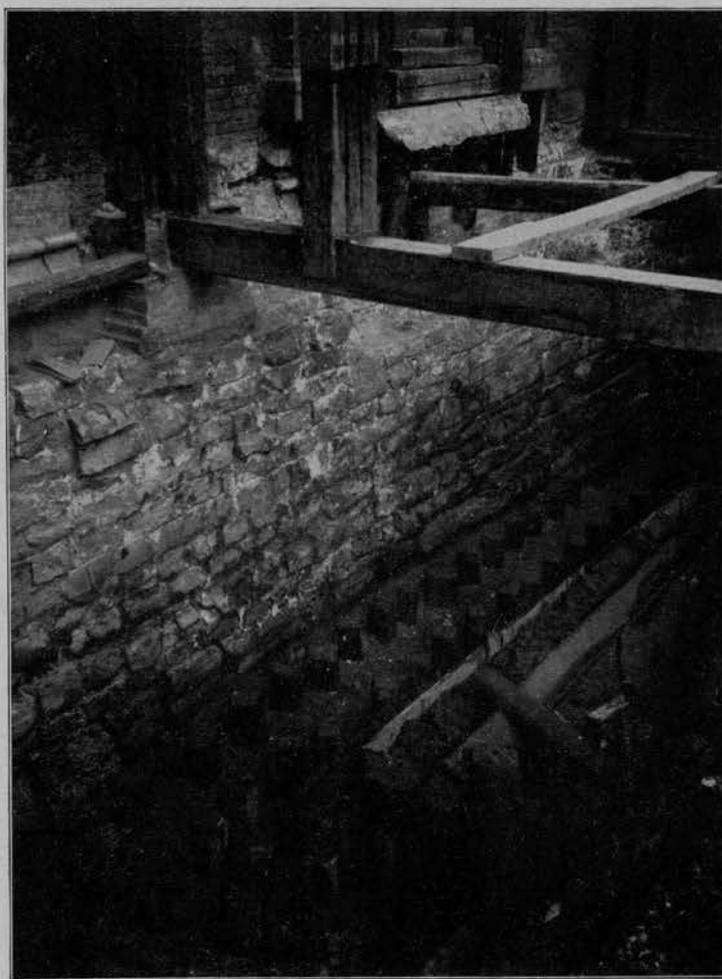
Rinforzo della fondazione sotto il muro del finestrone Vivarini.
